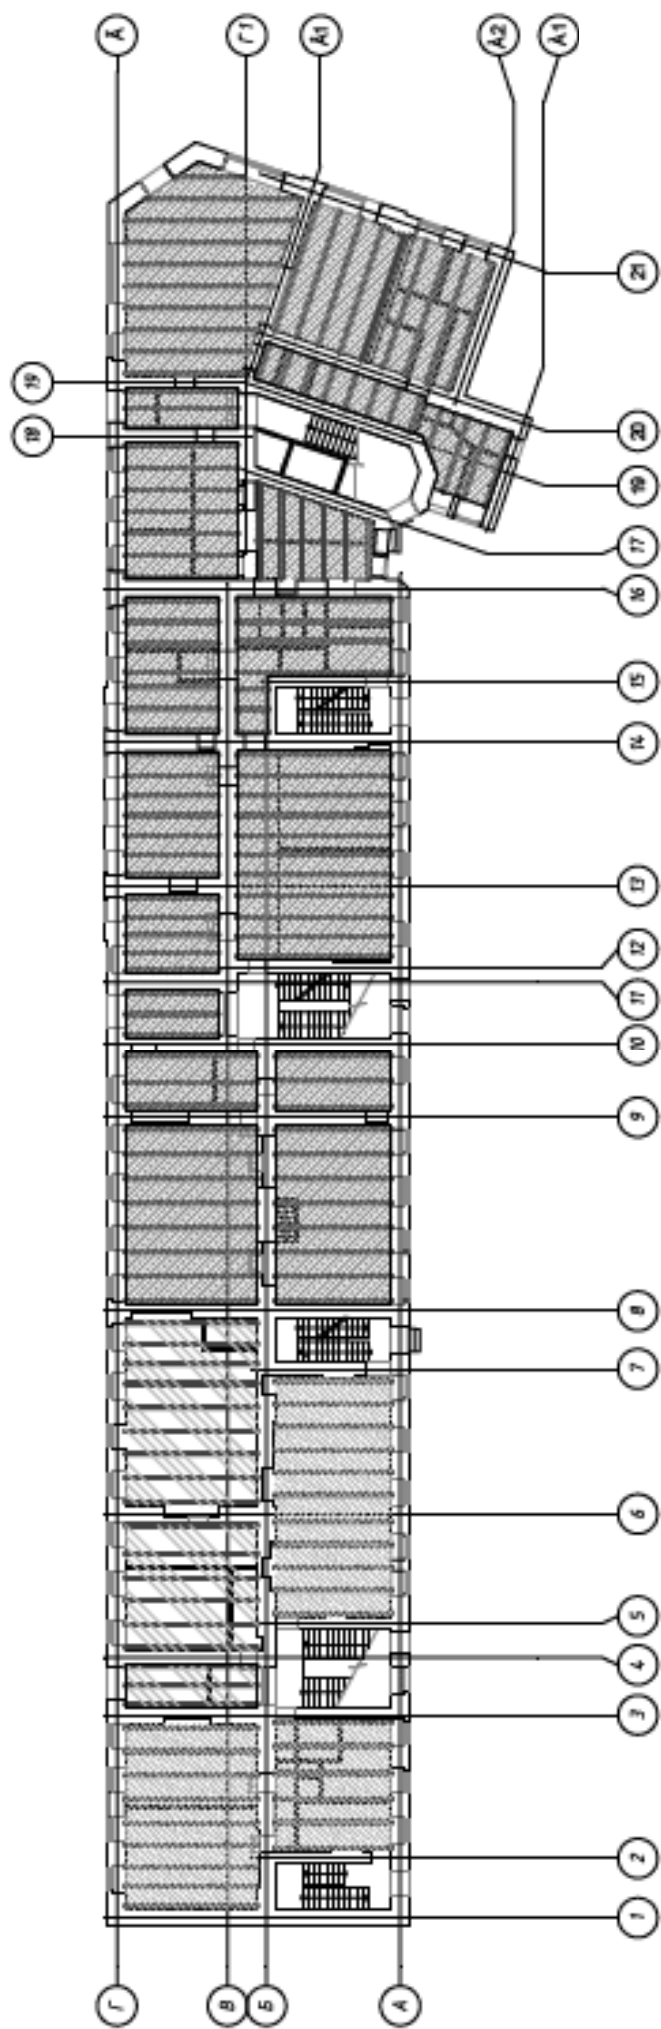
Схема расположения балок 1-го этажа (шаг балок 1000-1250 мм)
